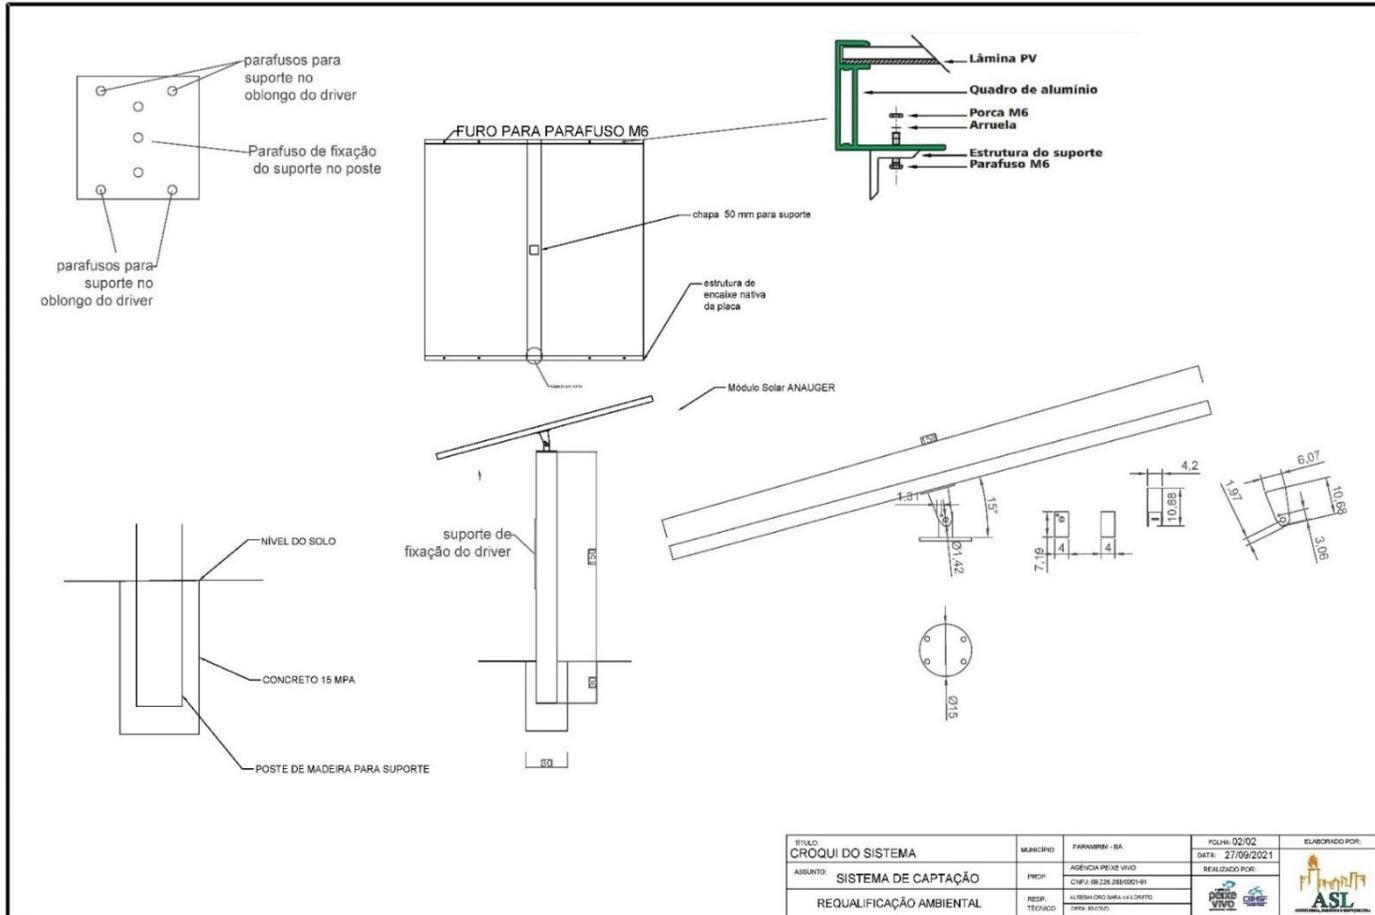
Croqui do suporte para instalação dos módulos solares instalado
